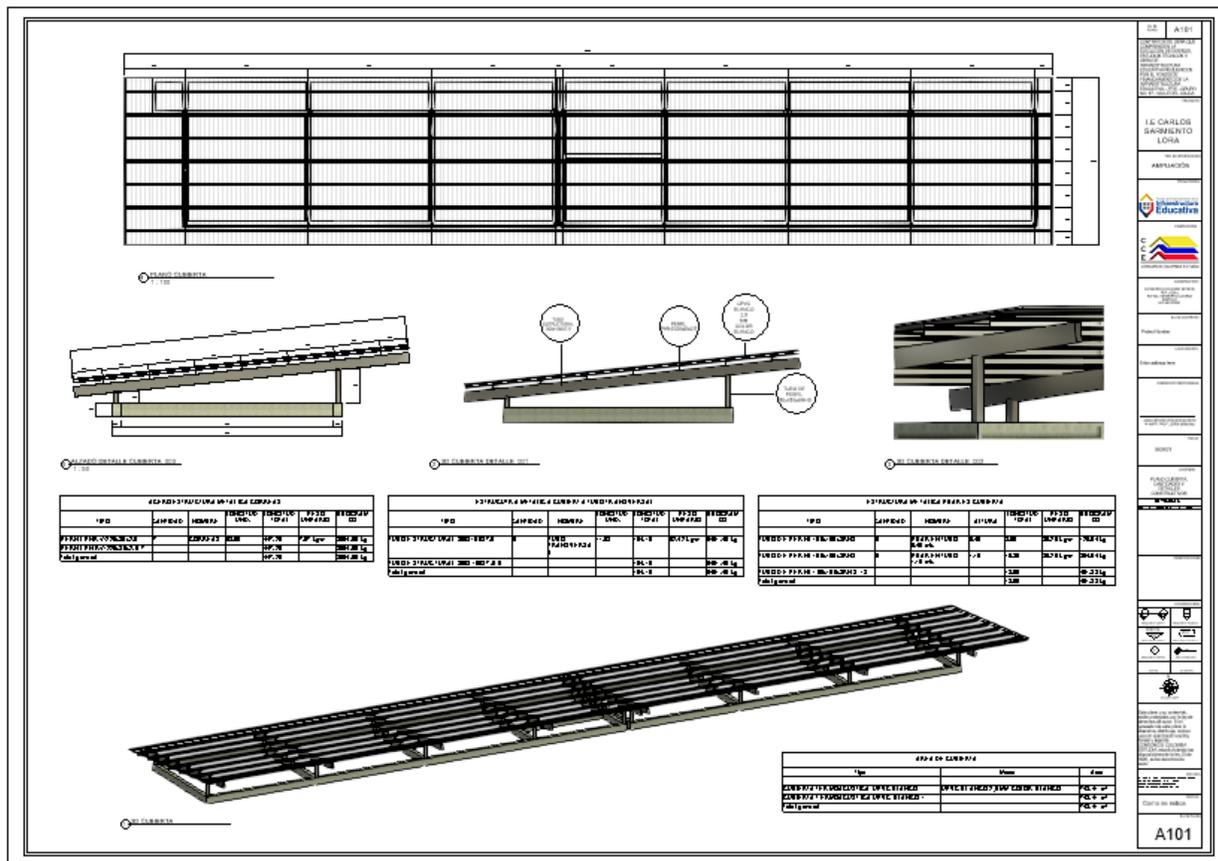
Diagramación de planimetrías de cubierta, detalles constructivos, modelo 5D con rotulo para entrega a obra.
